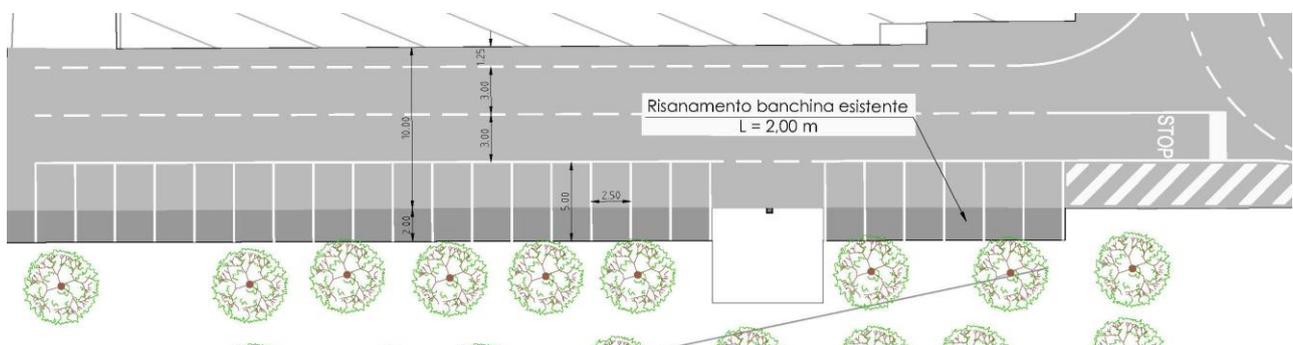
Planimetria di progetto tratto terminale – via Juvara
